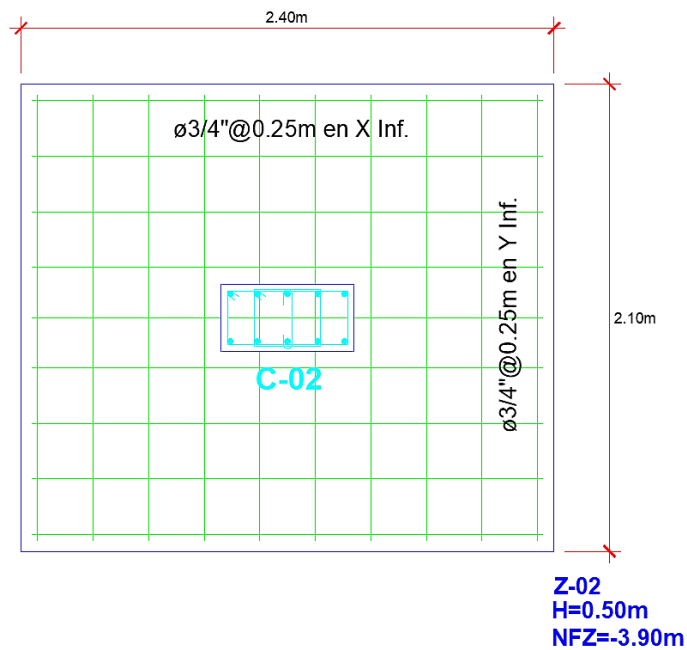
Detalle del refuerzo en concreto armado vista en planta (Zapata-Relleno fluido)
